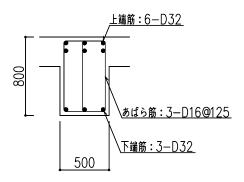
大ばりの配筋図(地下1階, YC通り X33~X34通り間,端部)(単位:mm)
